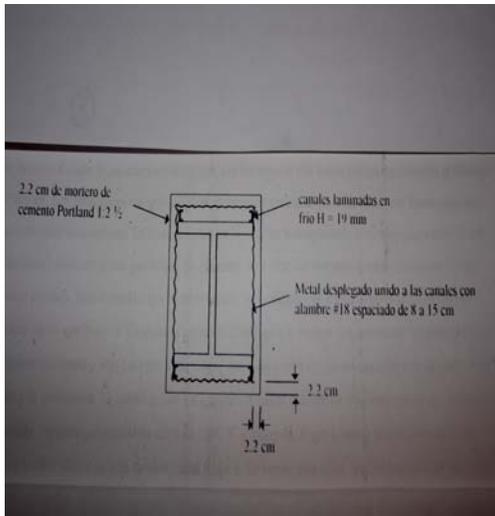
Protección de columna de acero por mortero de cemento (F60).
